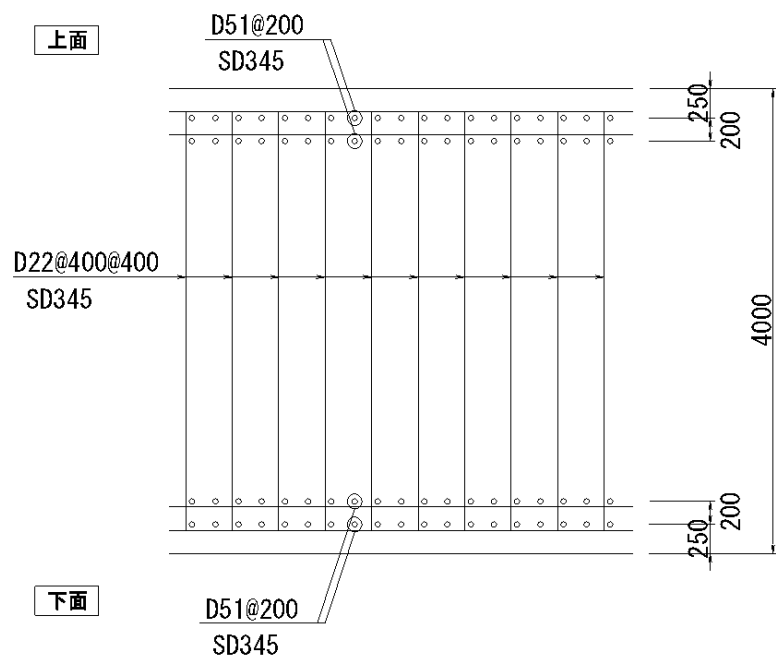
(2) 漂流物対策工基礎スラブの概略配筋図 (B-B 断面)
